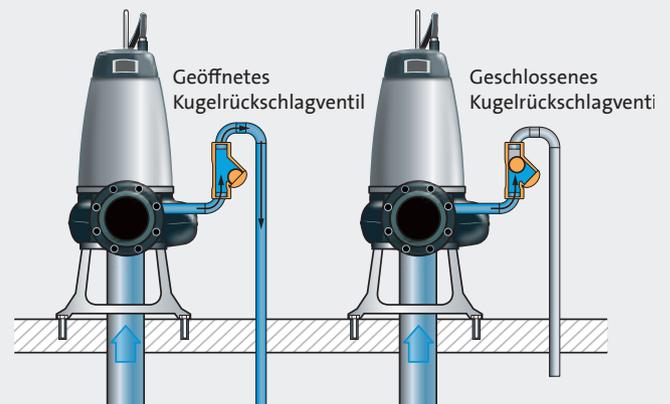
Darstellung der trocken aufgestellten Abwasserpumpe mit Kugelrückschlagventil mit Kugelschwimmer und Abflussrohr zurück zum Pumpen-Sammelbrunnen
